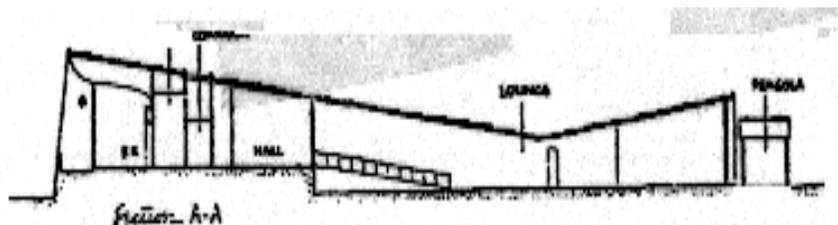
Corte longitudinal, detalhe do zenital empregado por Niemeyer para o Hotel de Nova Friburgo. Fonte: – Lauro Cavalcanti, 2001, p. 190
